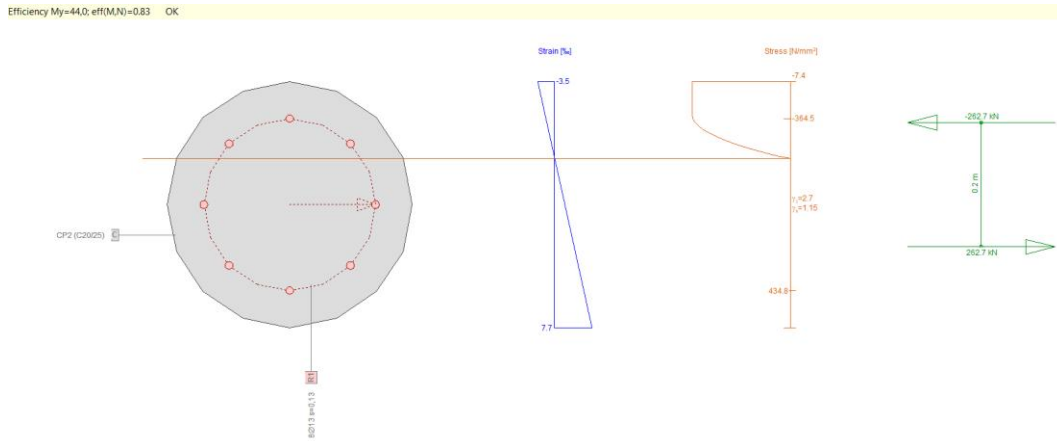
Comprovação a flexão da estaca do pilar perimetral
